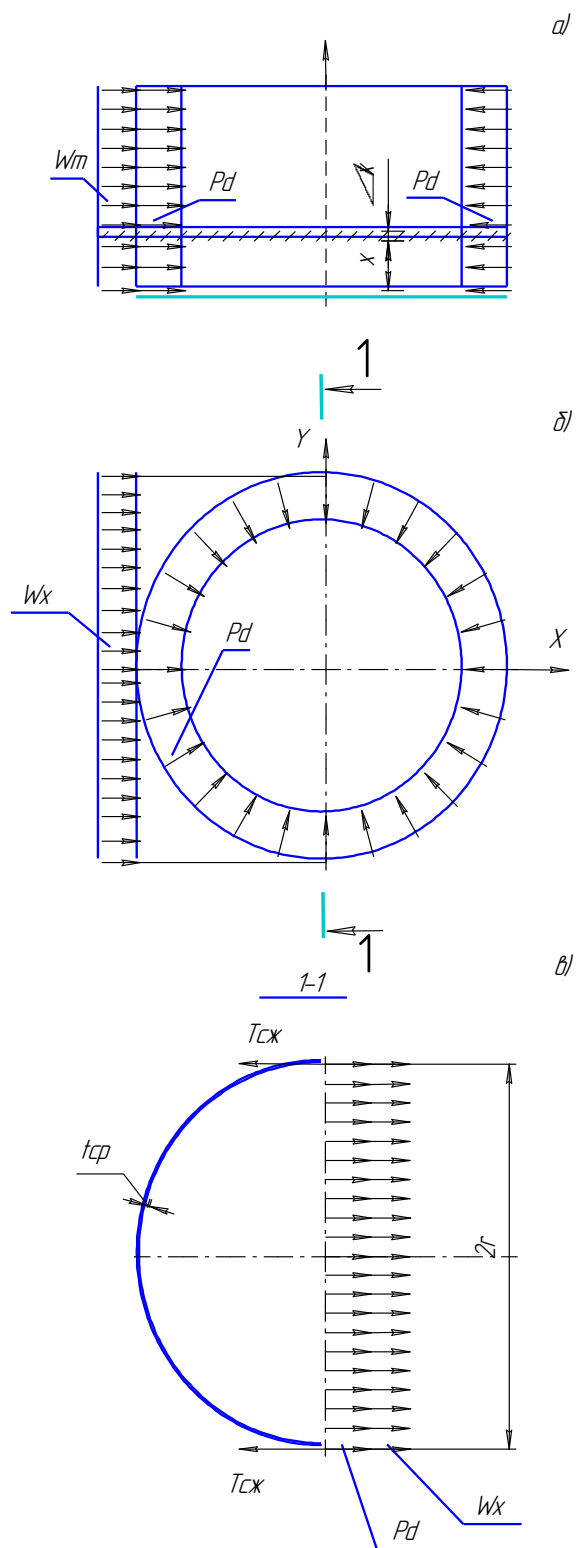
Расчет устойчивости стенки от вертикальных (кольцевых) нагрузок и воздействий: а)-схема нагружения; б)-расчетная схема
